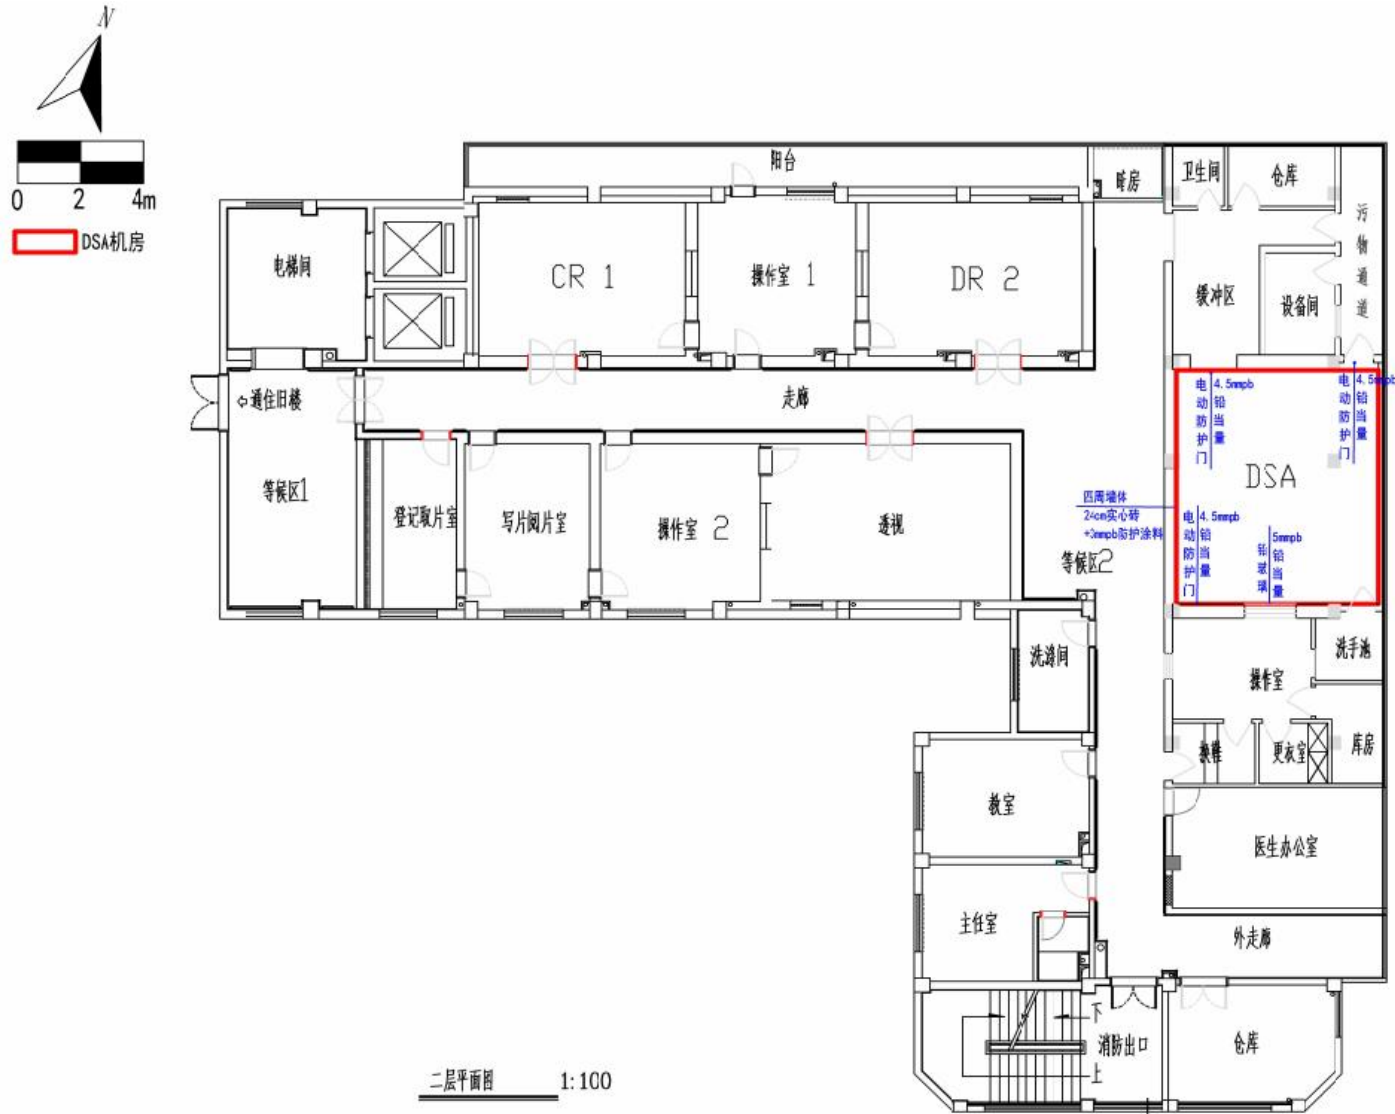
DSA 机房平面布置图 (门诊综合楼 2 楼)
